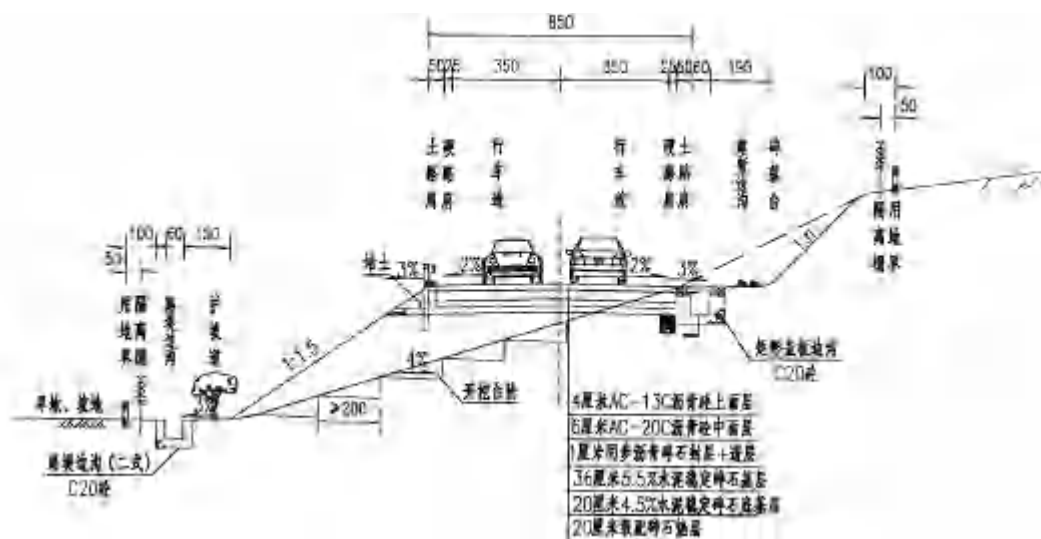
龙虎山连接线 8.5m 路基横断面图
